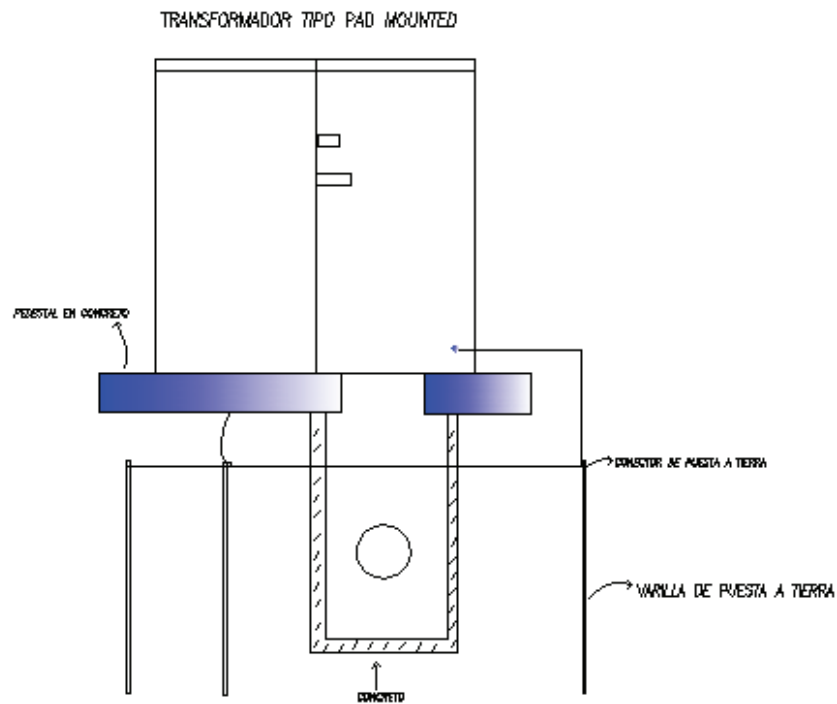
Transformador Tipo PAD MOUNTED vista lateral
